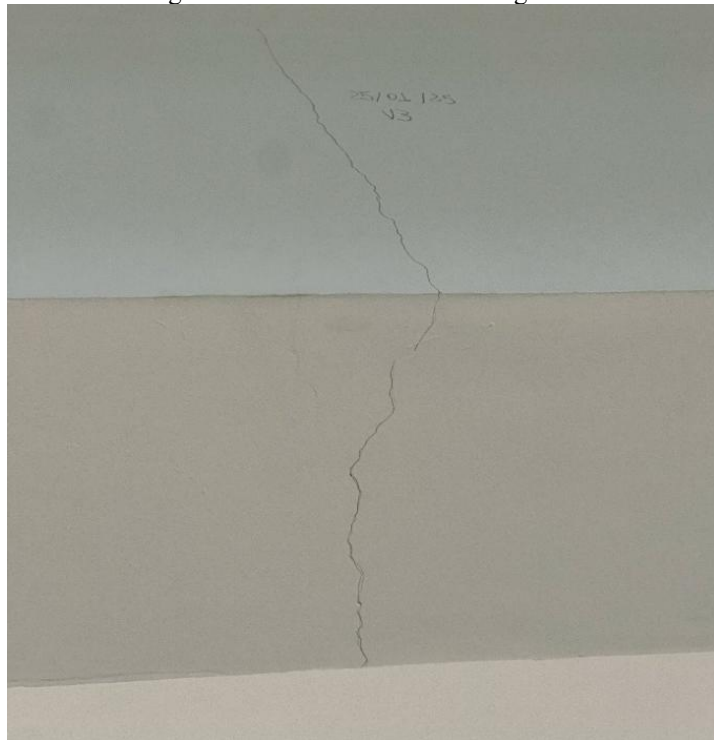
Fissuras analisadas nas vigas V2
